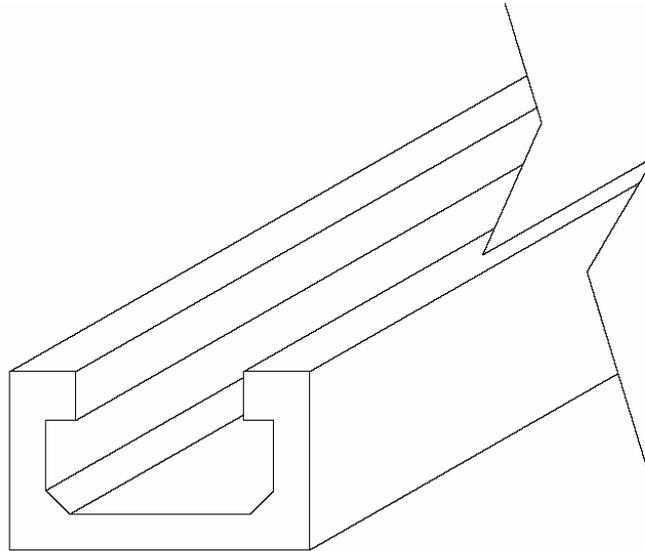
Detalhe da seção da viga calha “U”.
